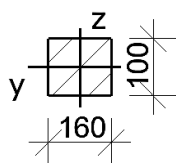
vnitřní nosná konstrukce 4NP (nový stav)
